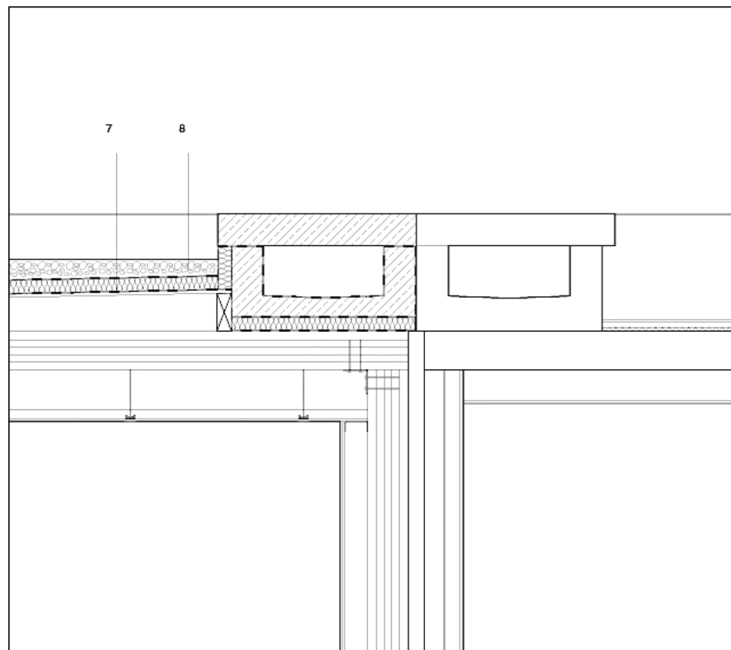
; Pormenor P3 da figura 4.23. 7 – Painel em madeira tipo OSB, 20mm; 8 – escoamento de águas com gravilha, 30mm.
